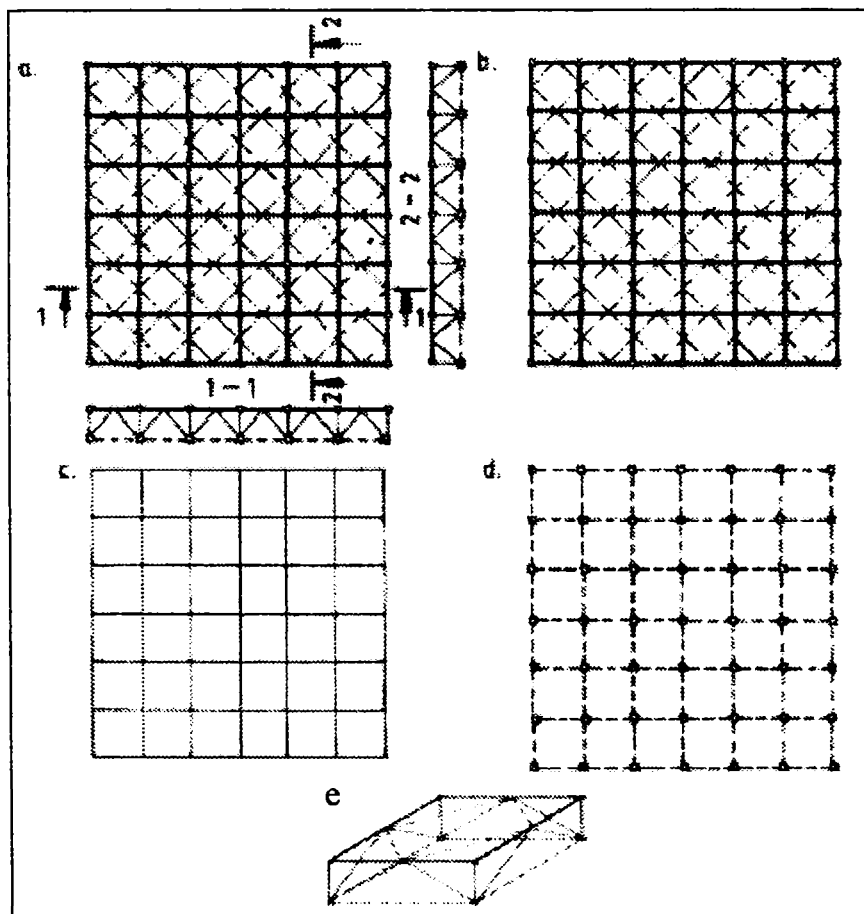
Structură spațială sistem reticulat cu tălpile superioare contravântuite suplimentar în plan orizontal și vertical
